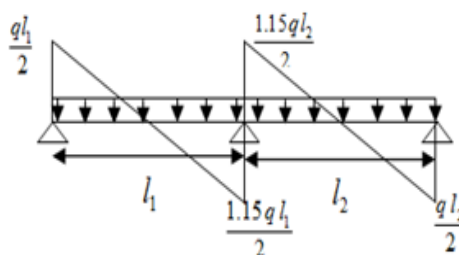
Effort tranchant d'une poutre a plus de 2
